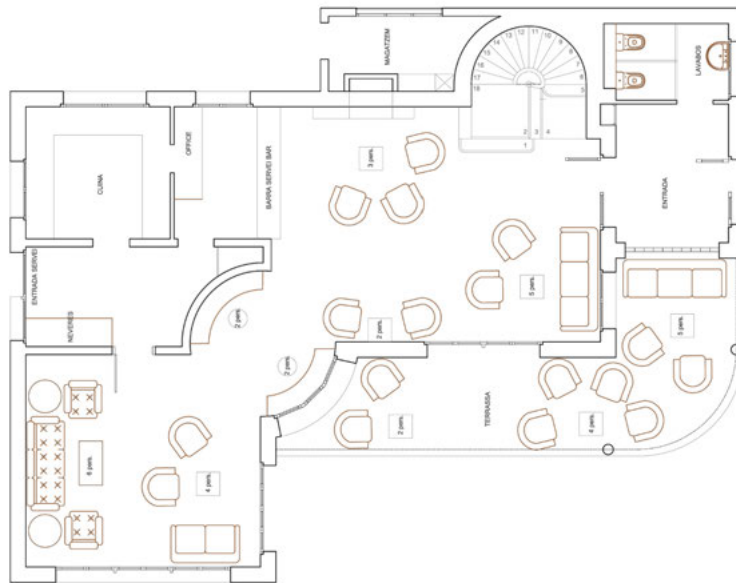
Planimetría de la planta baja con la propuesta para el «Espacio Acerbi». 2016. Tossa de Mar
